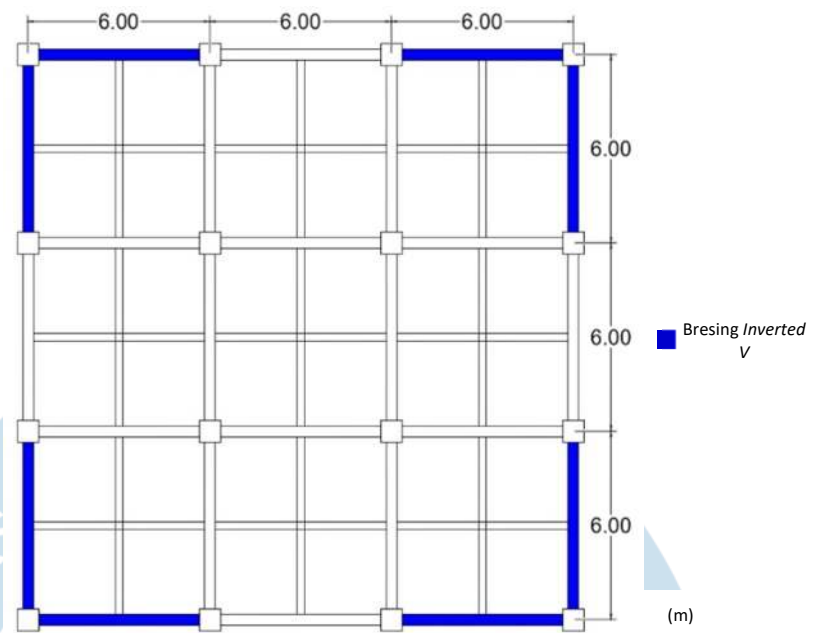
Denah Struktur dengan Bresing V Tengah
